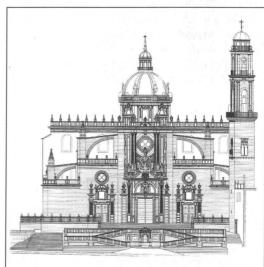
Catedral de Jerez. Fachada principal (Diáñez)
